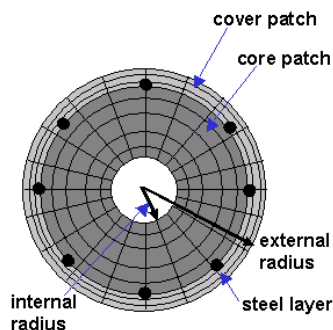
Esquema Sección tipo Fibra utilizada en pilotes y columnas.
